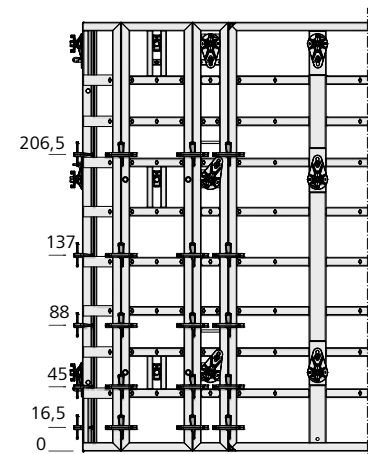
Hauteur de bétonnage jusqu'à 290 cm
